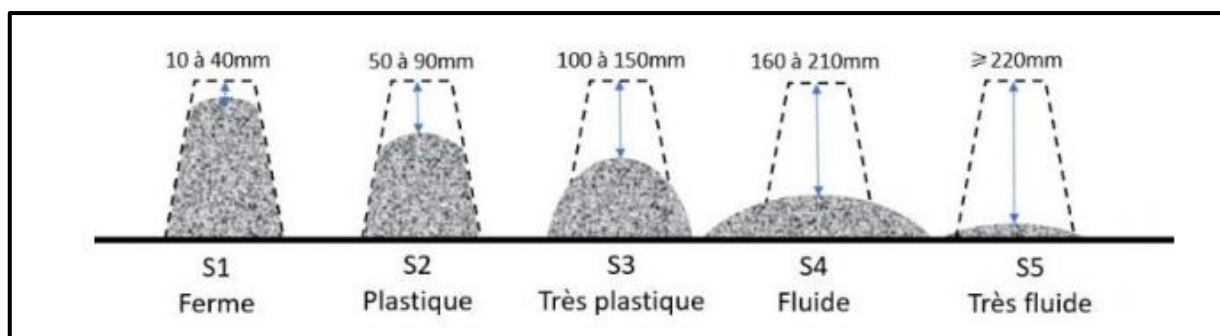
Les différentes classes de consistance du béton (essai affaissement béton).
